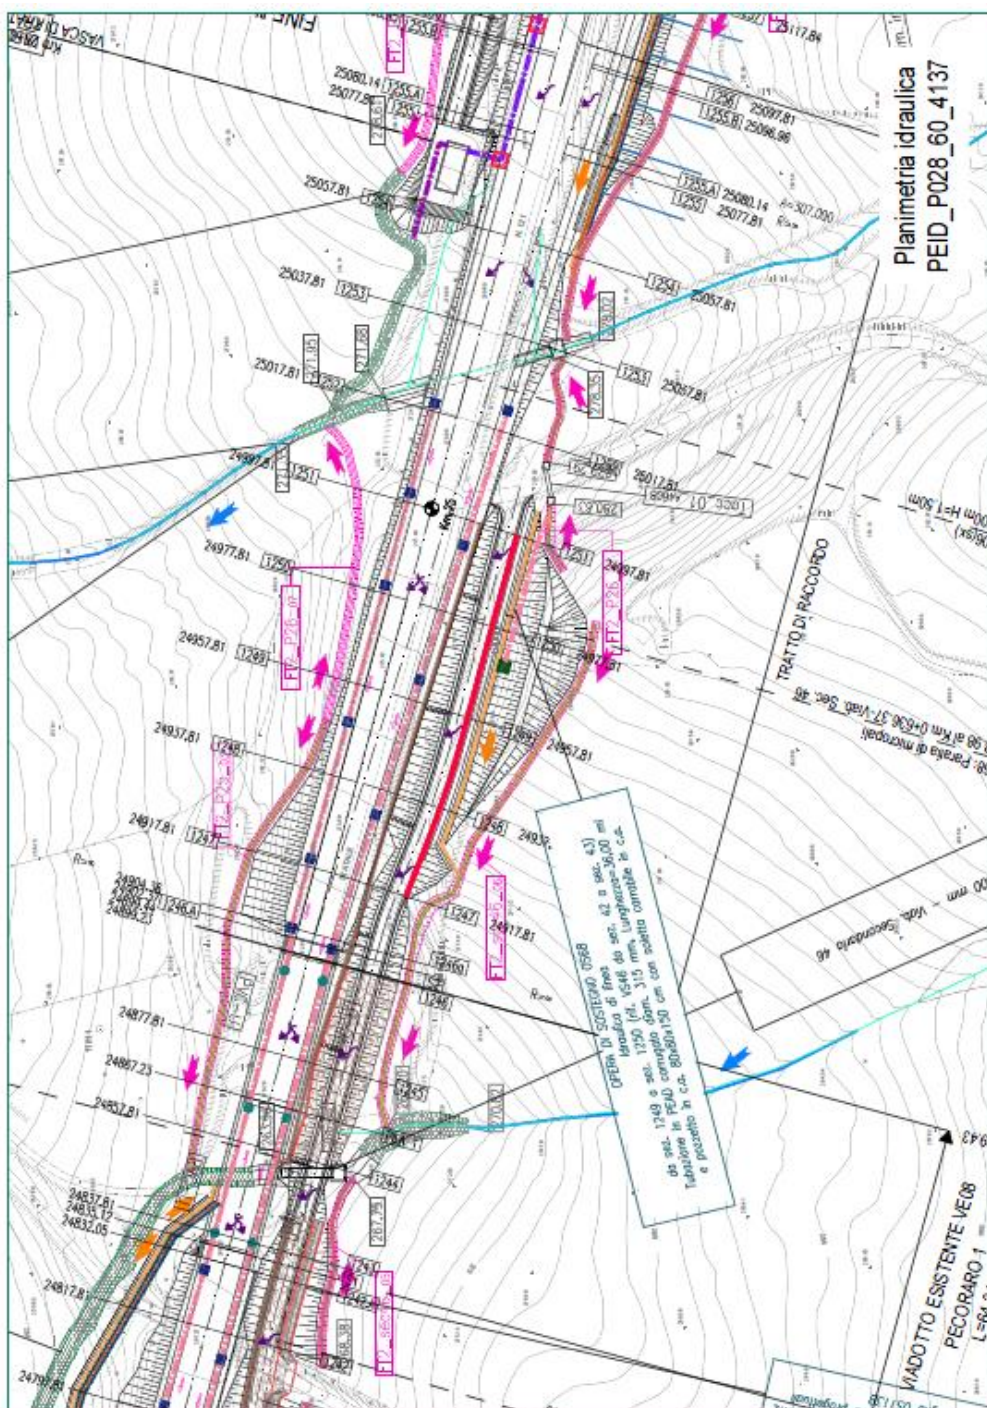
Stralcio planimetria idraulica revisionato - idraulica di linea OS68.
